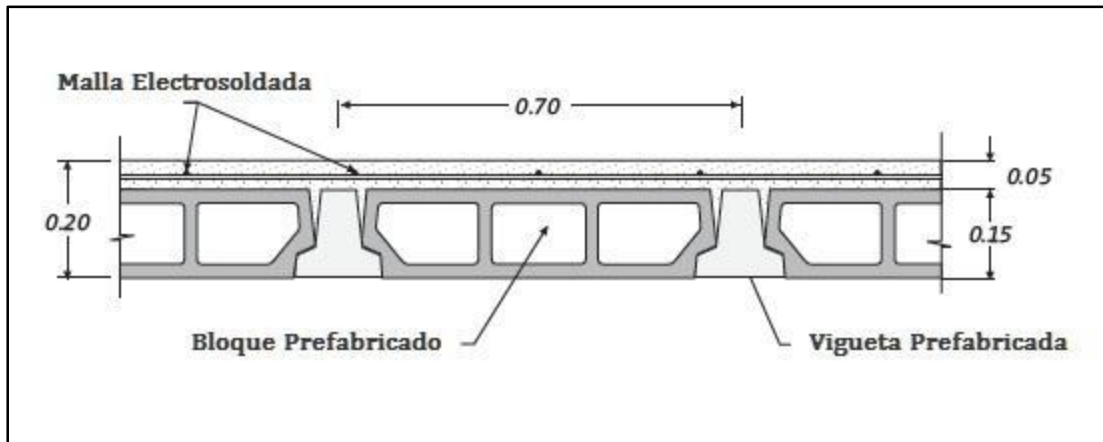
Esquema del sistema de bloques y viguetas con sobre losa chorreada en sitio.
